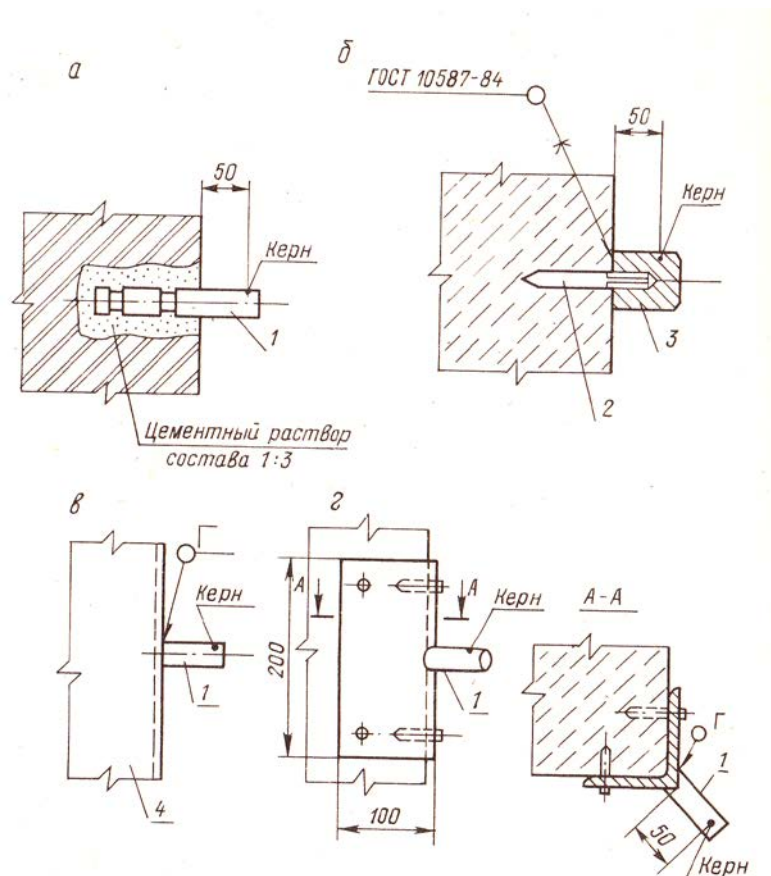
Конструкция ственных реперов: а – с заделкой в стене, б – с дюбелем, забиваемым строительно-монтажным пистолетом; в – на металлоконструкциях, г – при необходимости измерения взаимно перпендикулярных расстояний между колоннами; 1 – репер; 2 – дюбель ( $d = 10$  мм), 3 – головка репера; 4 – металлоконструкция
